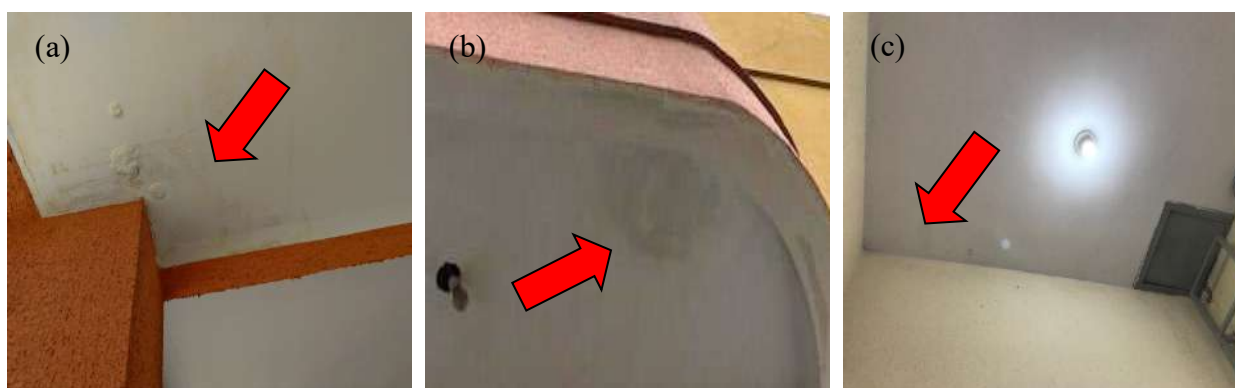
(a) Laje L01, (b) Laje L02, (c) Laje L03.
